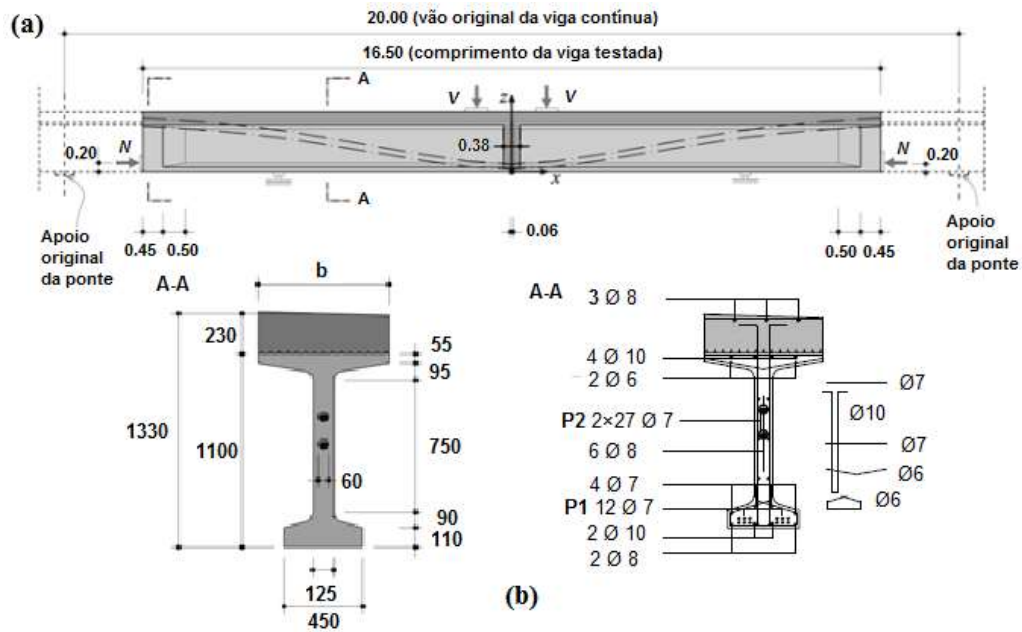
Geometria e disposição da armadura nas vigas testadas por Hars e Muttoni: (a) Secção longitudinal (valores em metros); (b) secção transversal e detalhe da armadura constituinte na secção A-A da viga (valores em mm) [34] [35].
